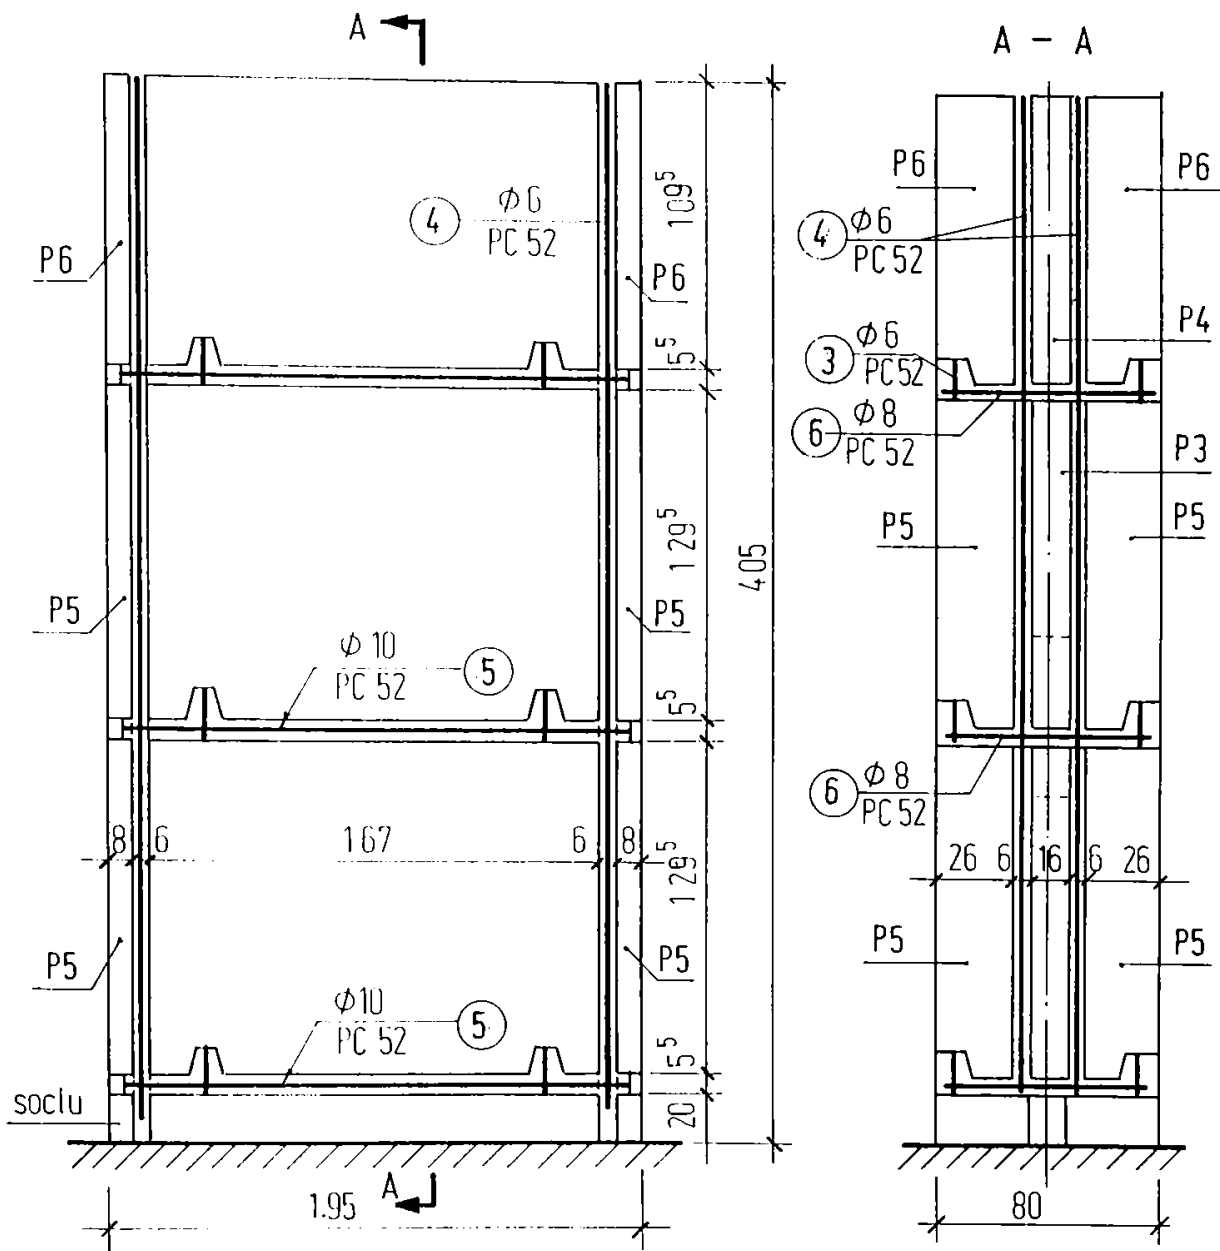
PERETE STRUCTURAL PREFABRICAT - MODEL F6 -
